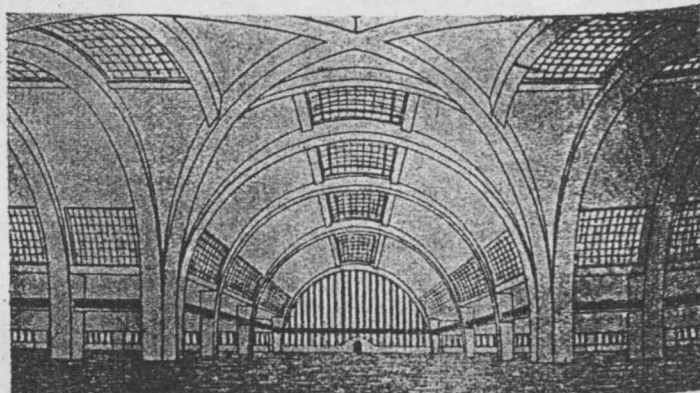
Zentralmarkthalle in Berlin. Wettbewerbsentwurf von Jansen. Halle in Eisenbeton.
